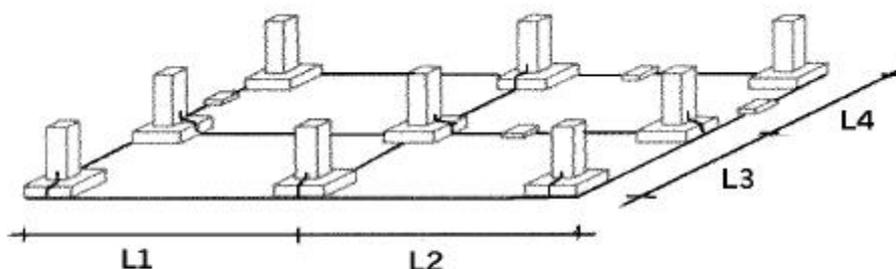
Cable enterrado, conectado a los pilares, que bordea el perímetro de un edificio
